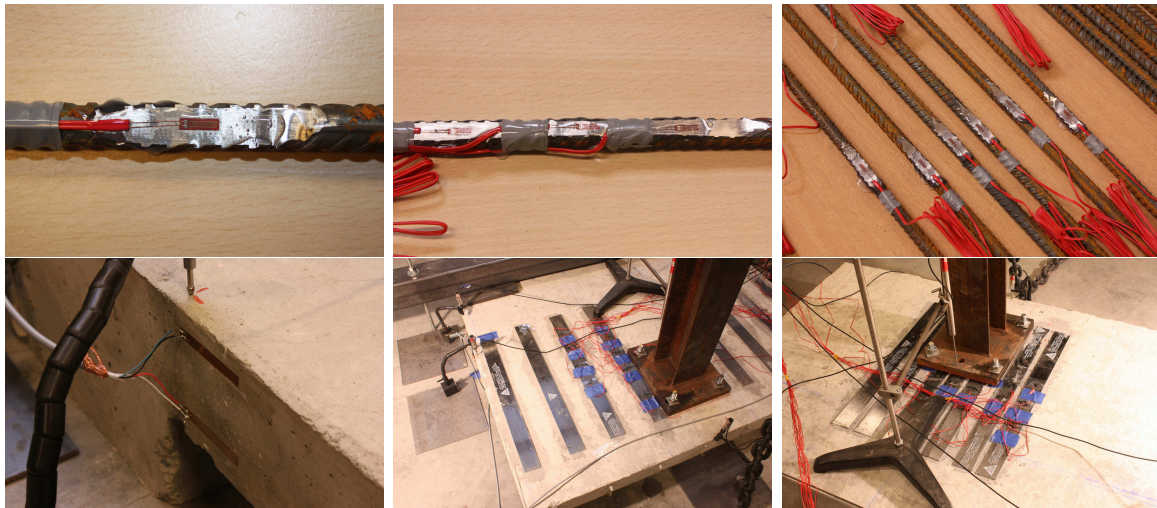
Jauges de déformation placées sur les armatures, le béton et le plat PRF
